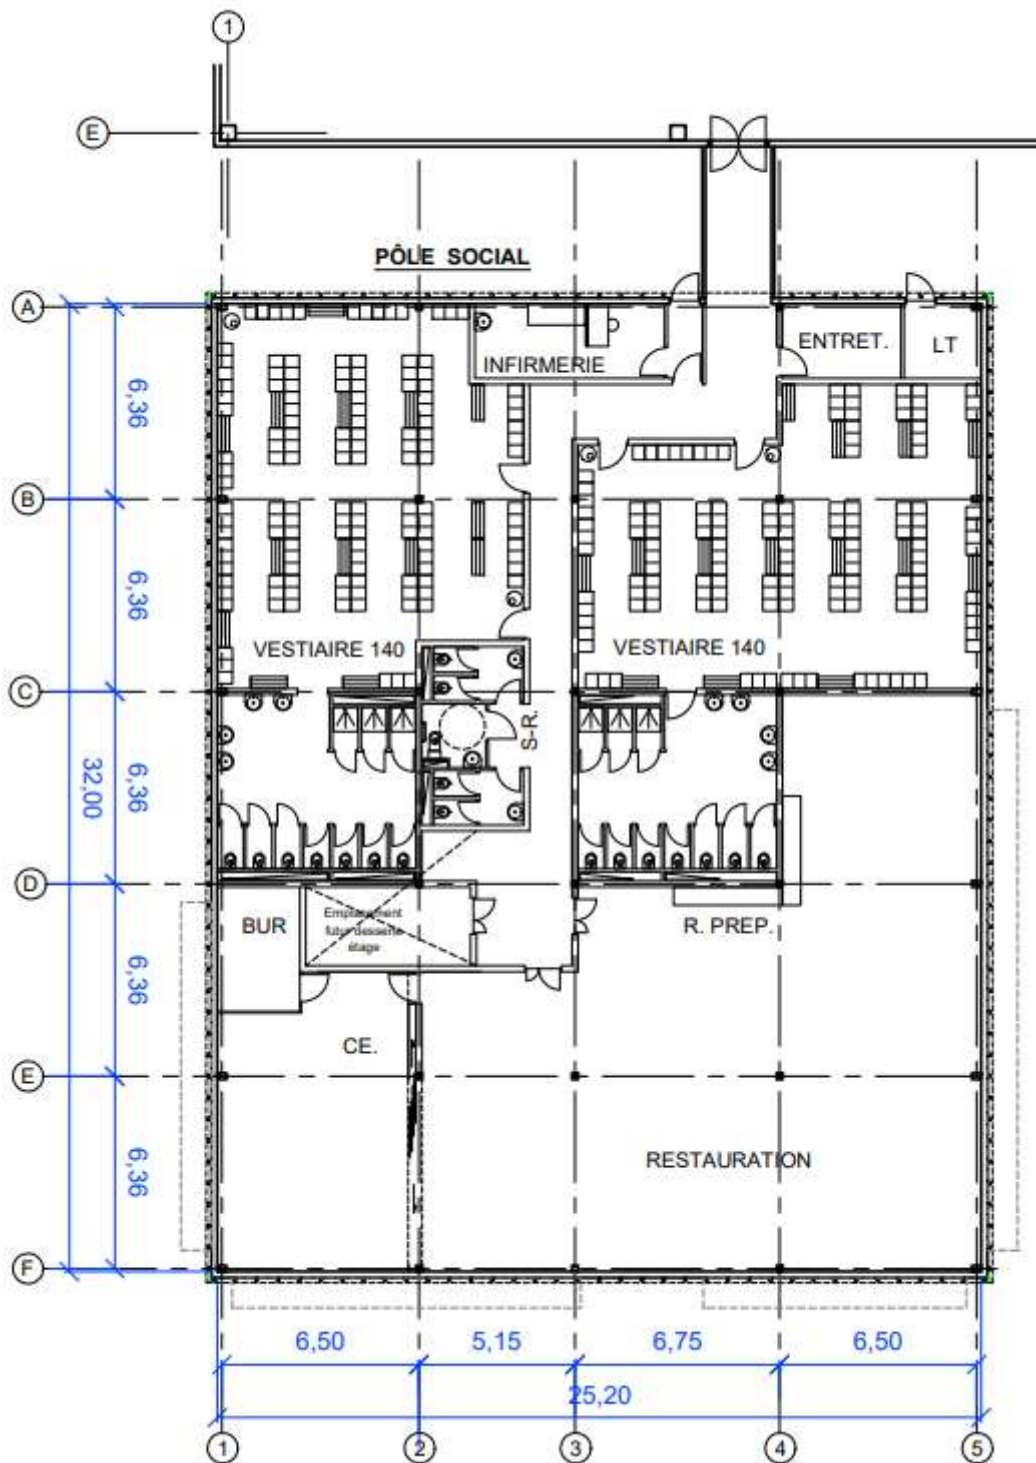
PLAN DE L'IMPLANTATION DU POLE SOCIAL
